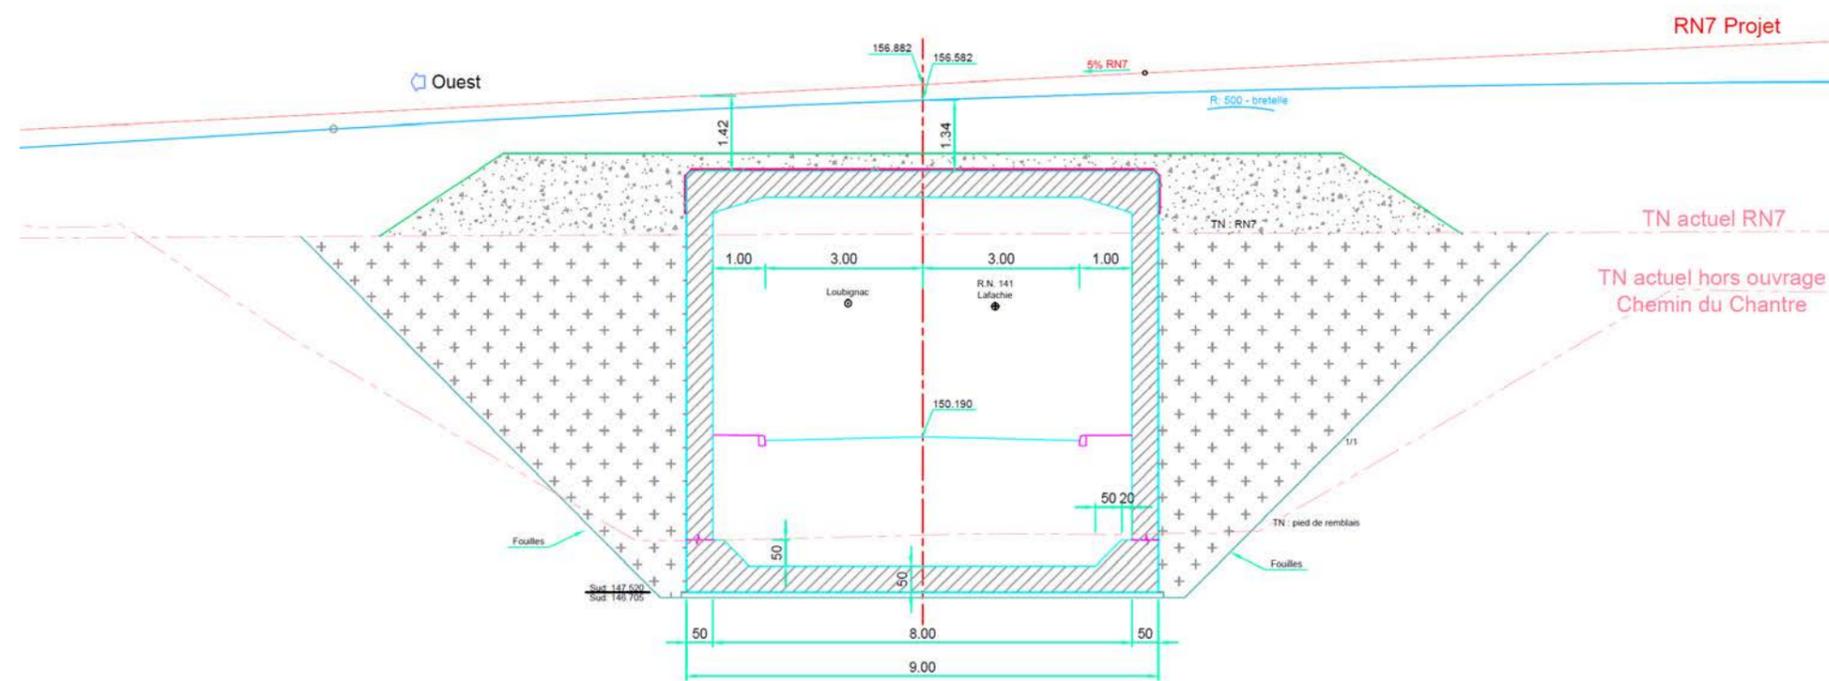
Coupe transversale de l'ouvrage d'art OA1
